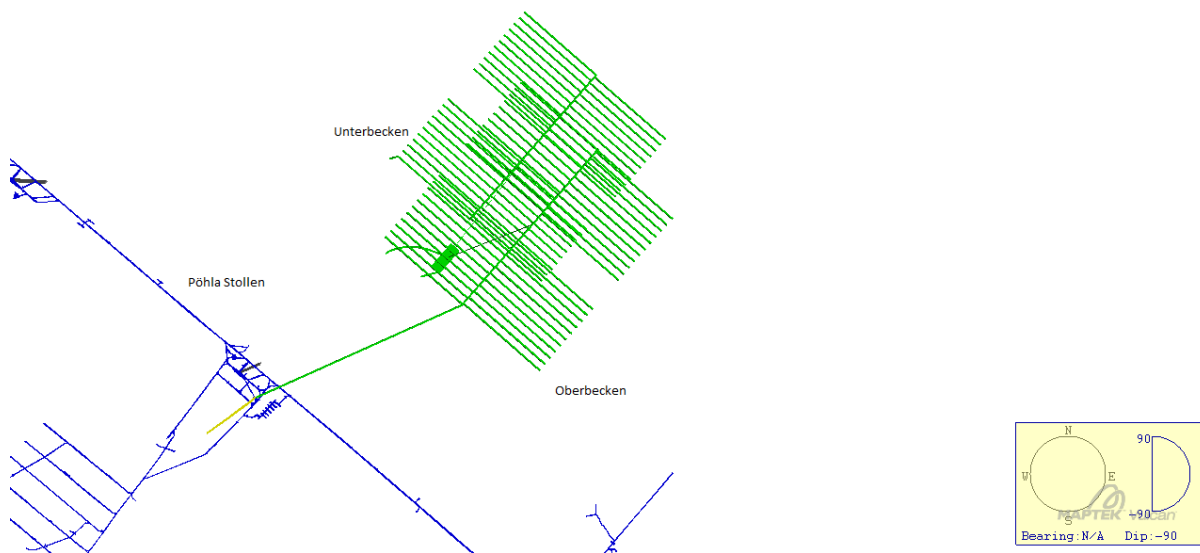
Grundriss des PSWuT- Bergwerk Pöhla
